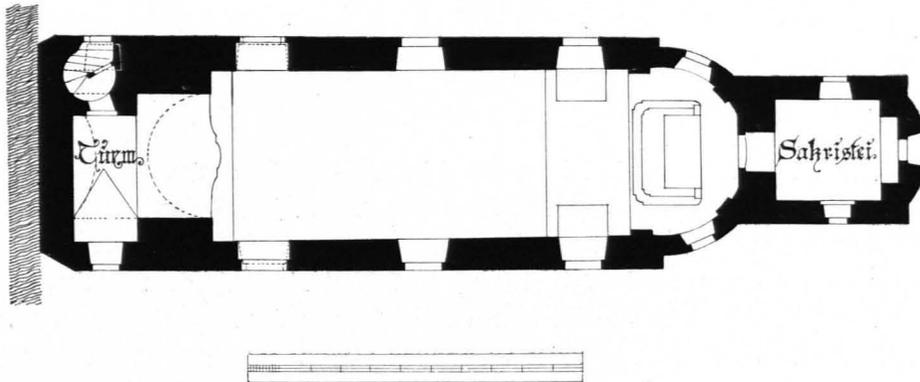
Groß-Poppen, Pfarrkirche, Grundriß 1:250 (S. 174)
